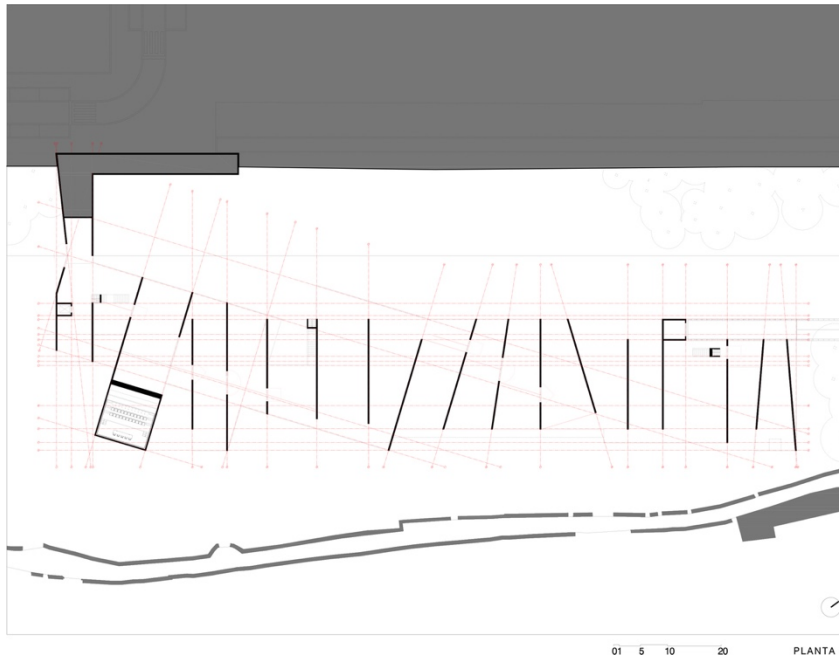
Planta piso 0 do Museu de Arte Contemporânea Nadir Afonso (Fonte_14)
